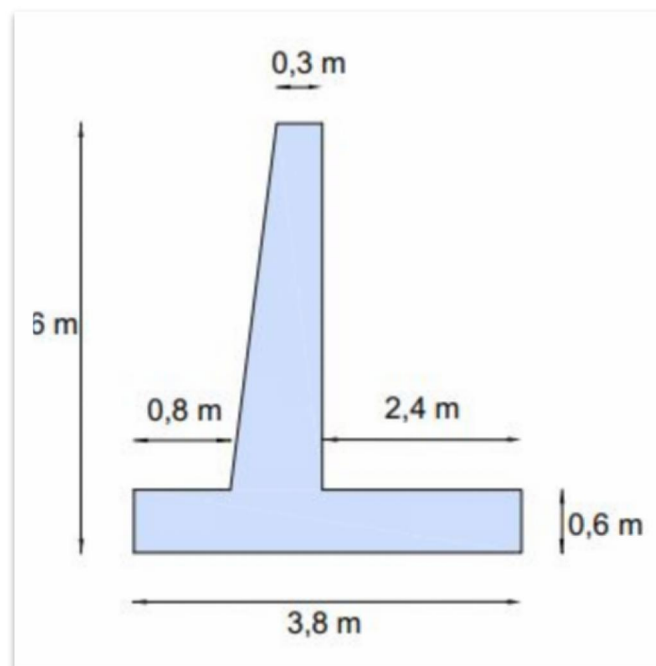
Pré-dimensionnement du mur de soutènement en BA étudié
